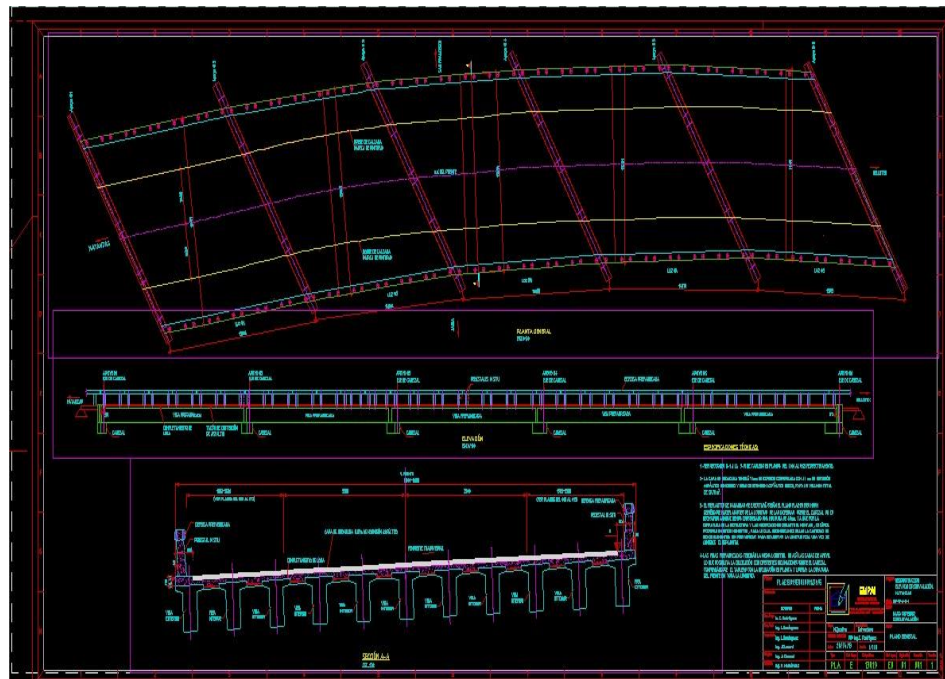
Plano General con la vista en planta y la sección transversal. (Elaboración propia)
